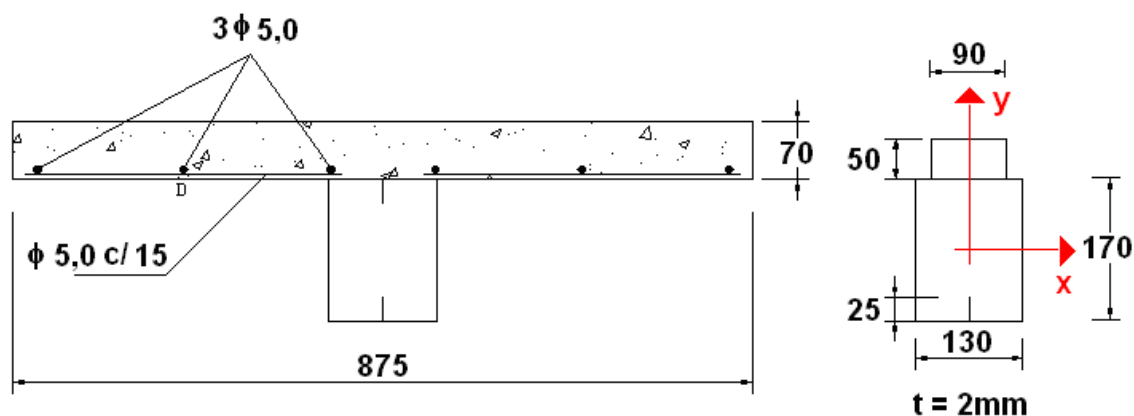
Seção transversal da viga mista (cotas em *mm*).
